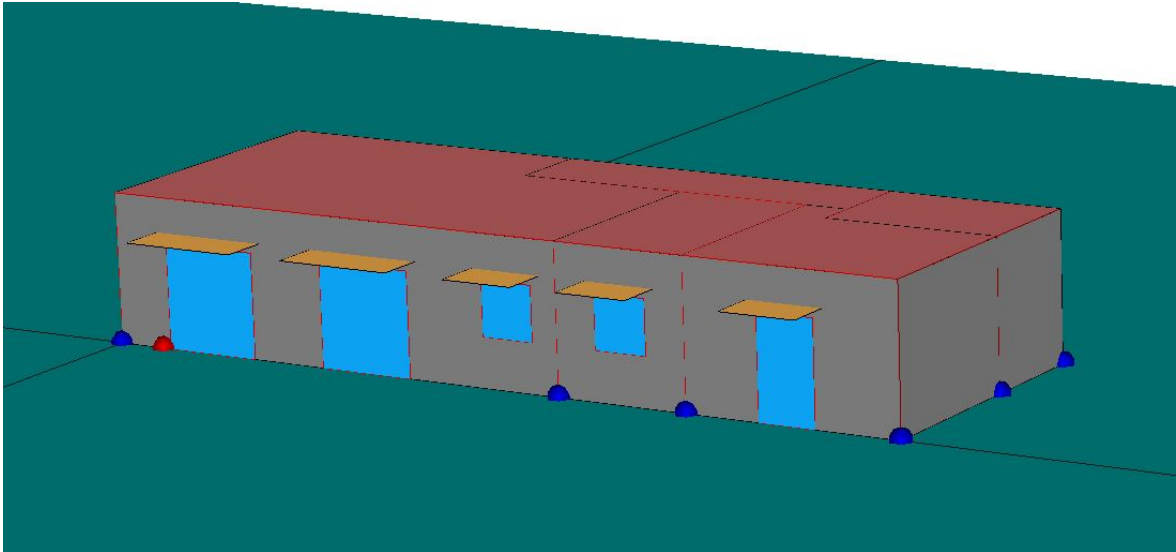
Modelado de la vivienda en HULC (vista fachadas sur y este)
